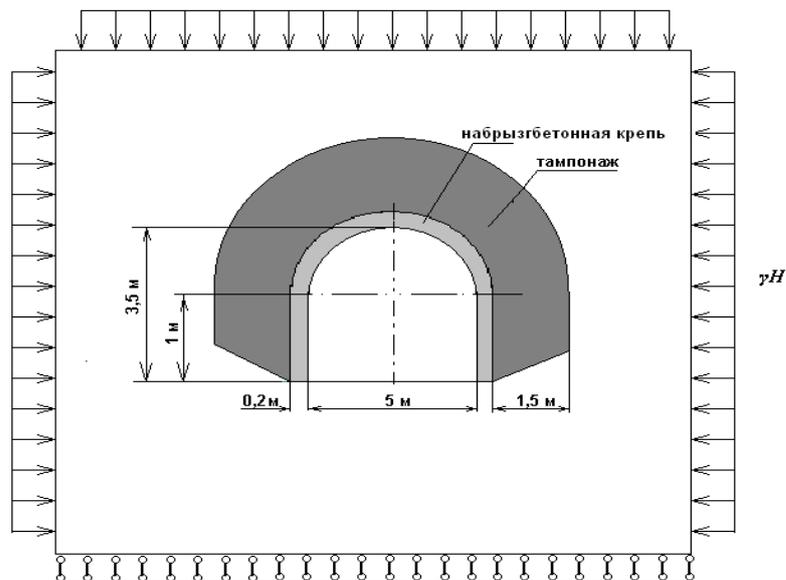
Расчетная схема выработки с набрызгбетонной крепью, толщиной 20 см и тампоном закрепного пространства на глубину 1,5 м
